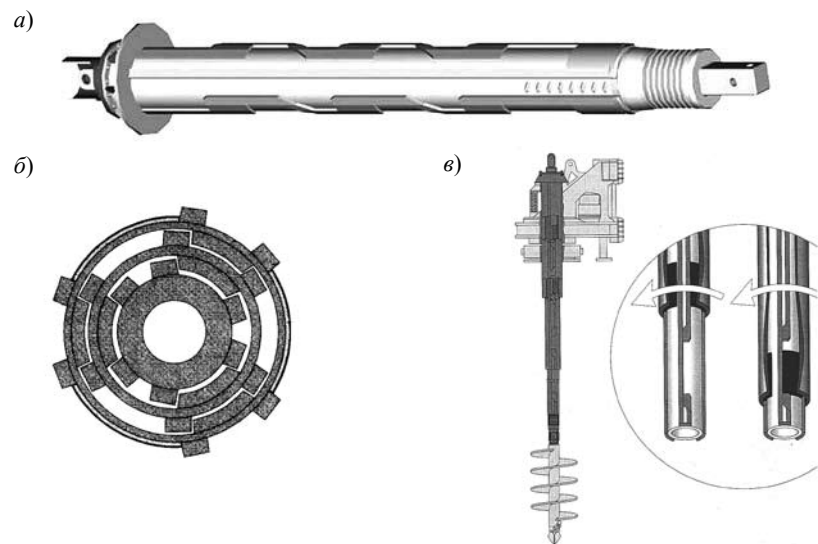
Телескопическая штанга Келли: а – внешний вид штанги; б – поперечный разрез; в – схема работы замкового соединения
